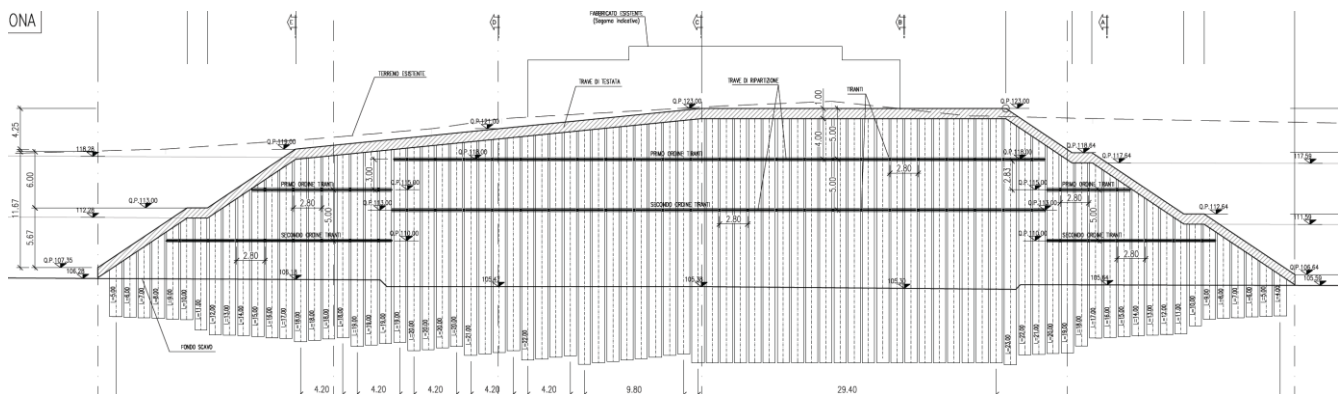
Sezione trasversale della paratia di pali a protezione dell'edificio alla progressiva 142+200 ca.
